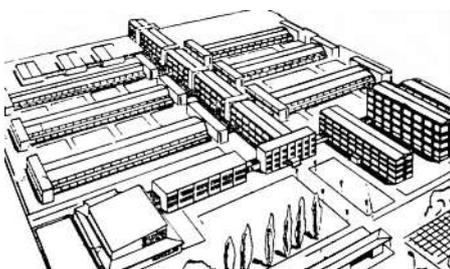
Entwurf für den Bau des Halbleiterwerkes aus dem Jahre 1960 [9]
